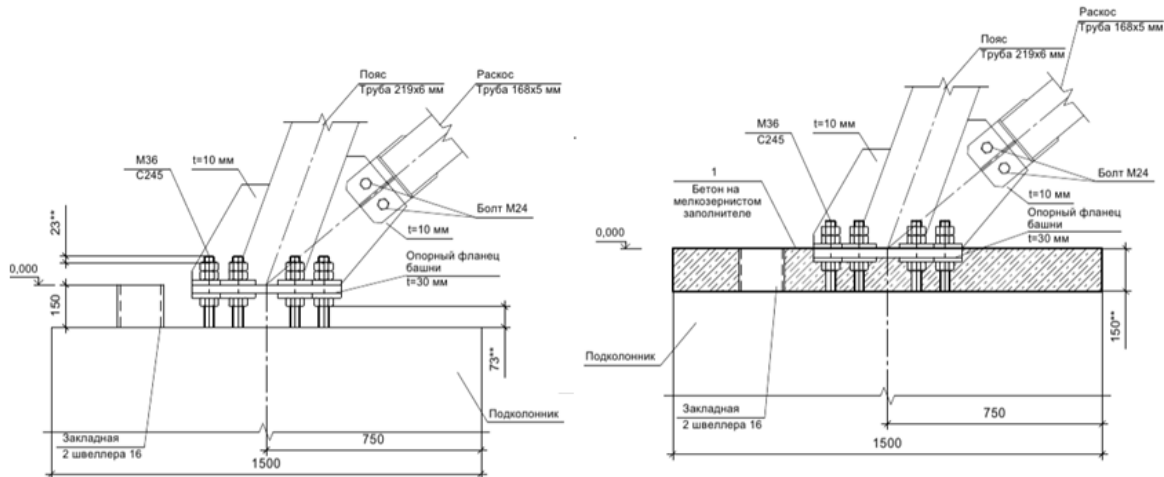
Схема опорных фланцев после демонтажа подбетонки и выравнивания опорных узлов
